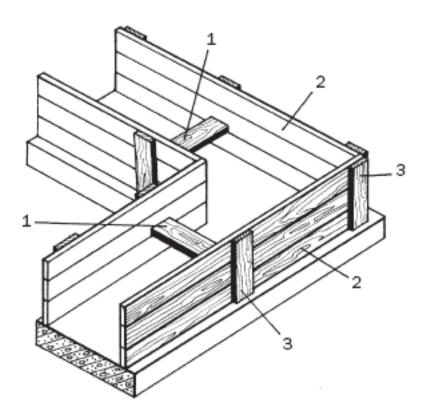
Установка опалубки: 1 – распорки; 2 – дощатые щиты; 3 – накладки
